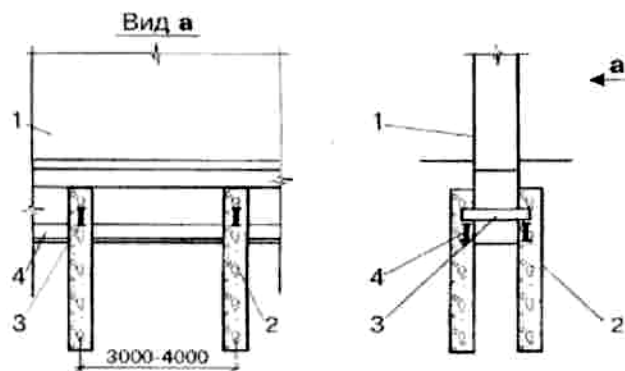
Схеми зміцнення фундаментів виносними палями з подовжніми балками: 1 – фундамент, що підсилюється; 2 – набивні палі; 3 – поперечні балки; 4 – подовжні балки
